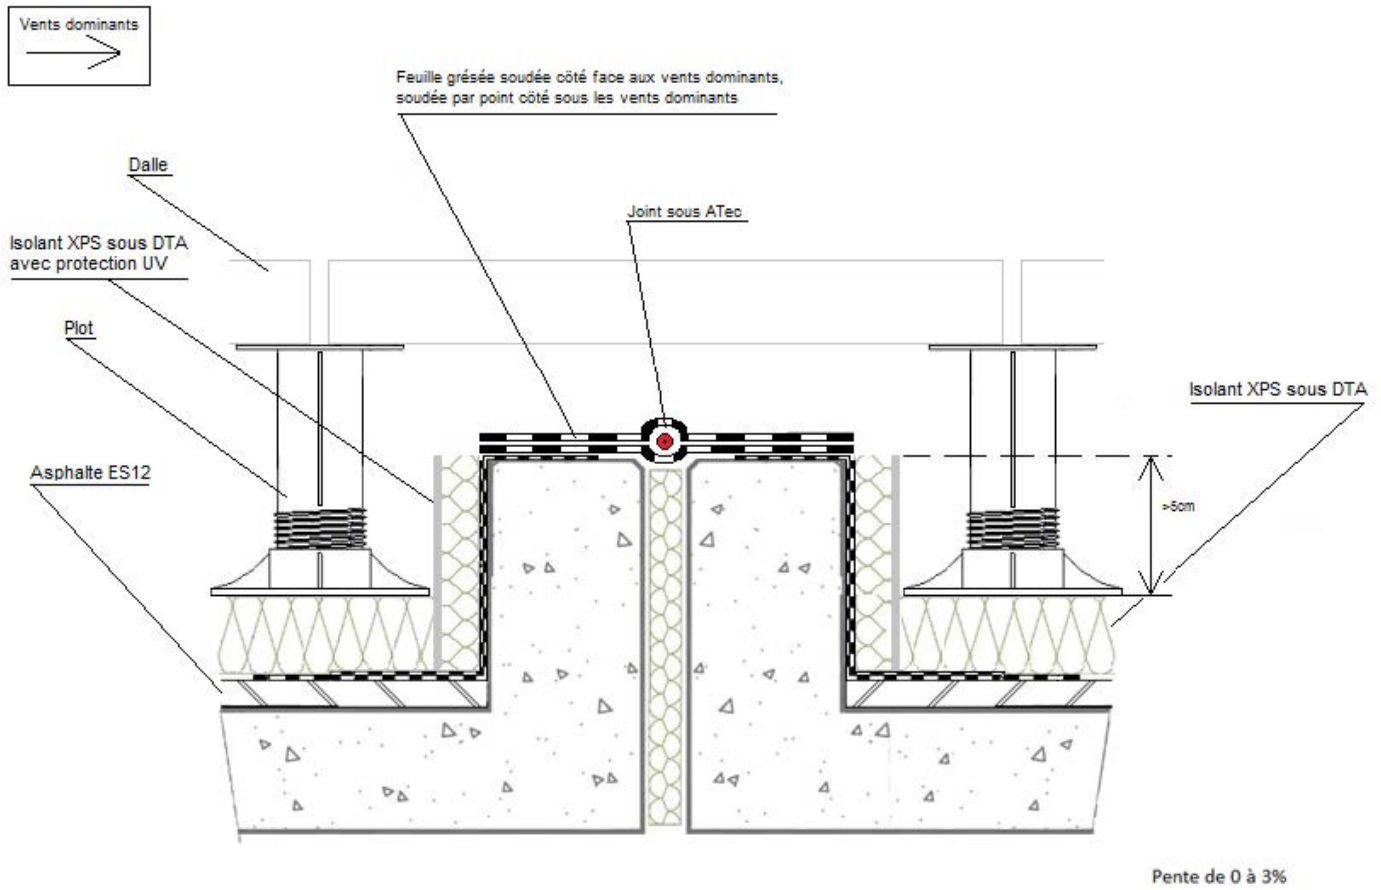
is – Joints de dilatation - Terrasse accessible, protection par dalle sur plots
